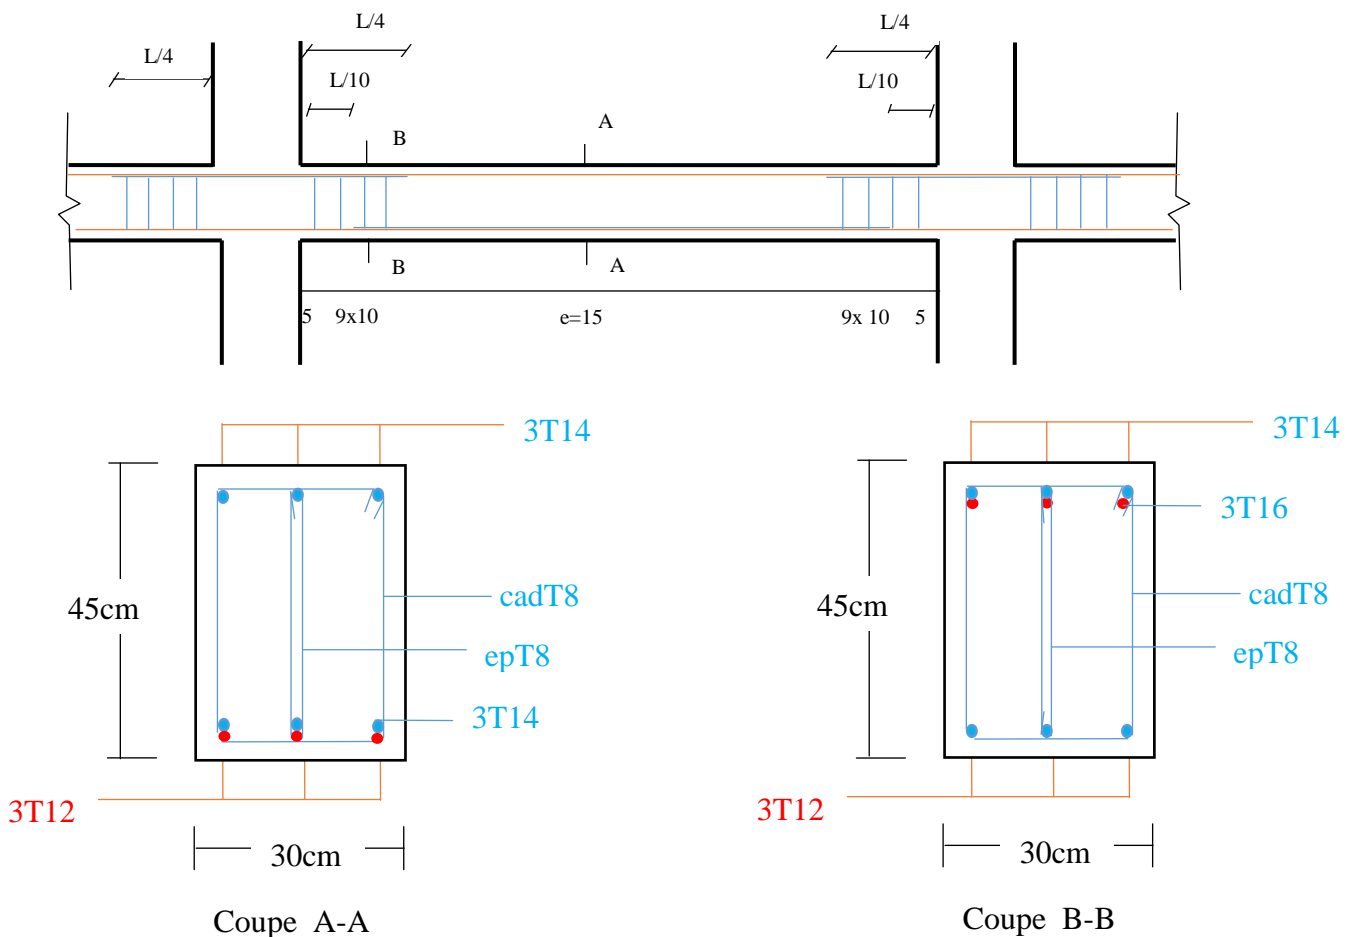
Exemple de Ferrailages des Poutres porteuses
